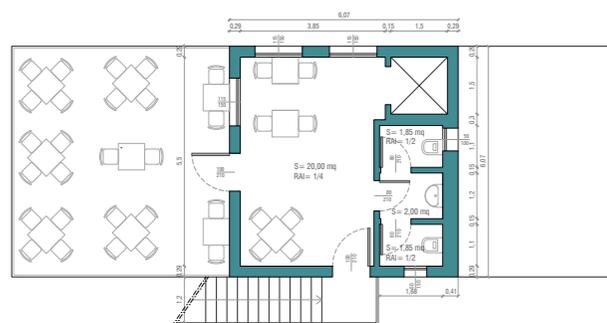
Pianta piano primo. Scala 1:200
